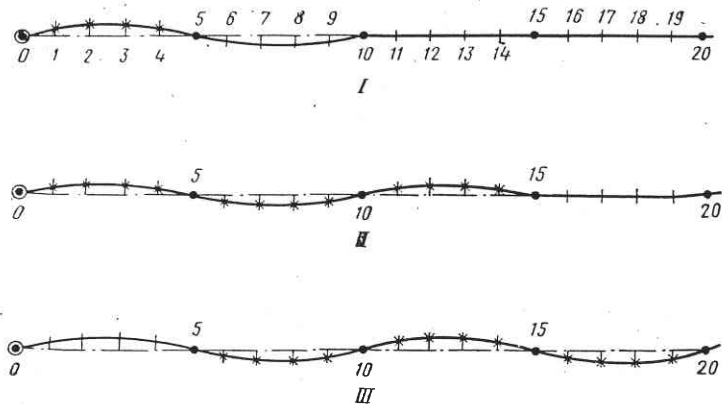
Схема монтажа упругоискривленного трубопровода
